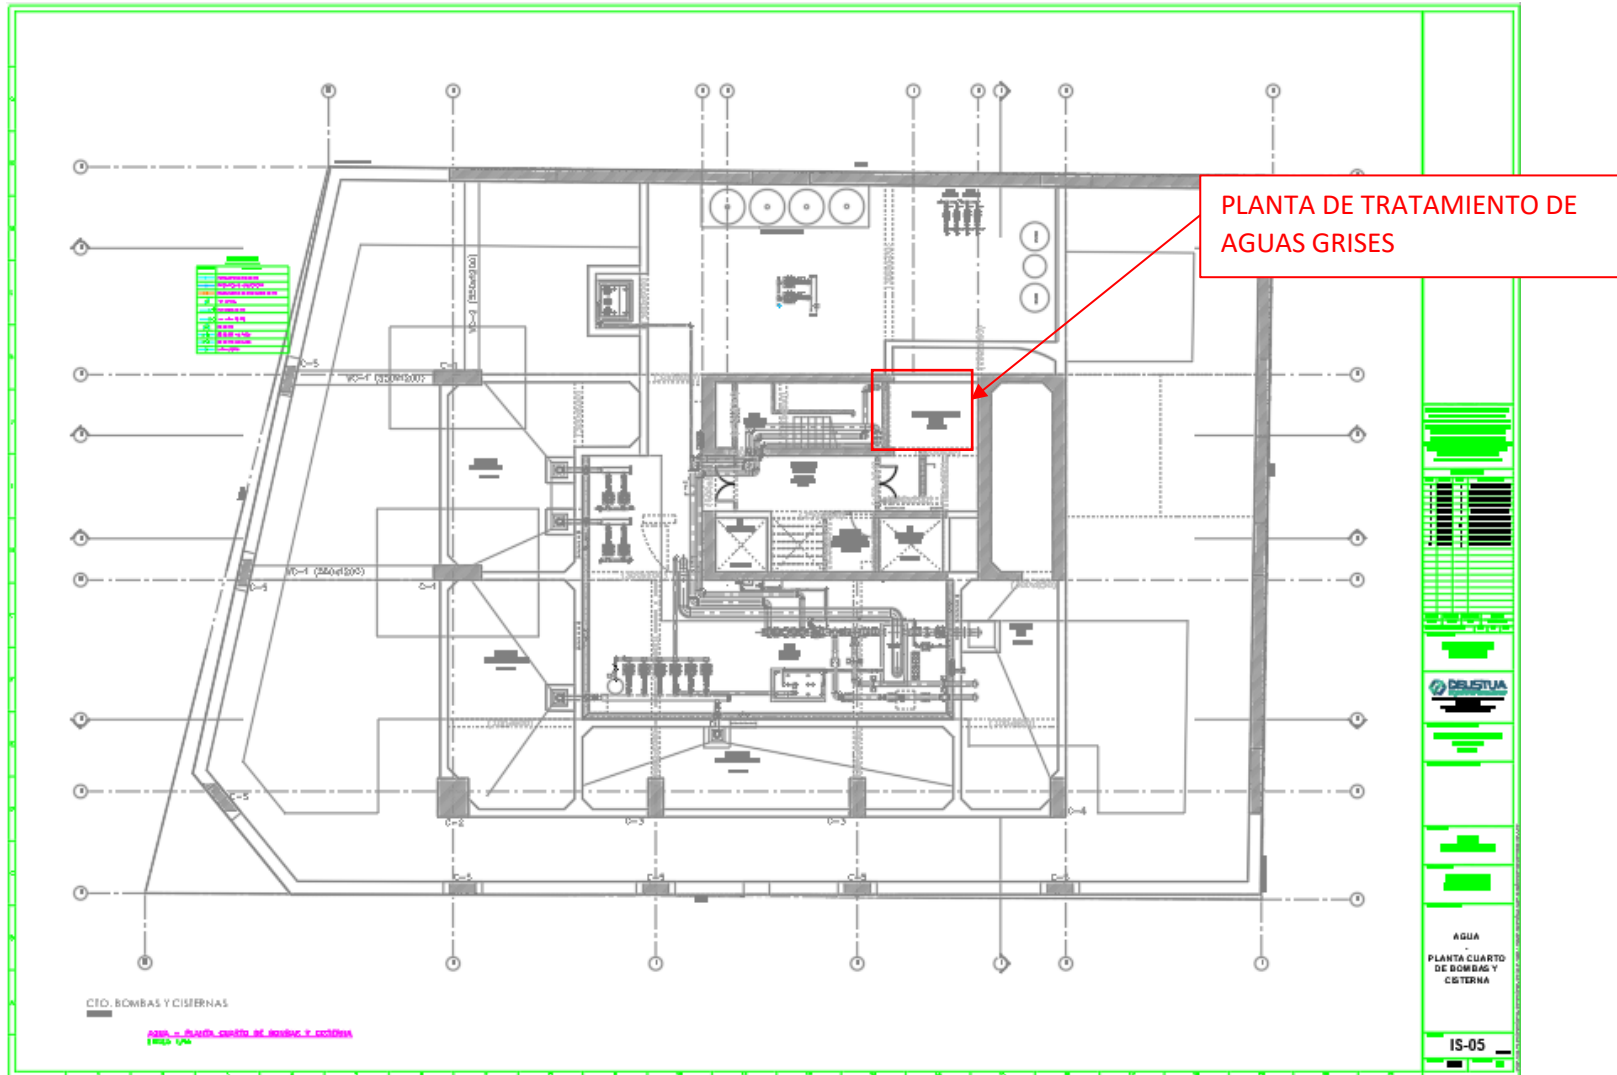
Ubicación de la planta de tratamiento de aguas grises
